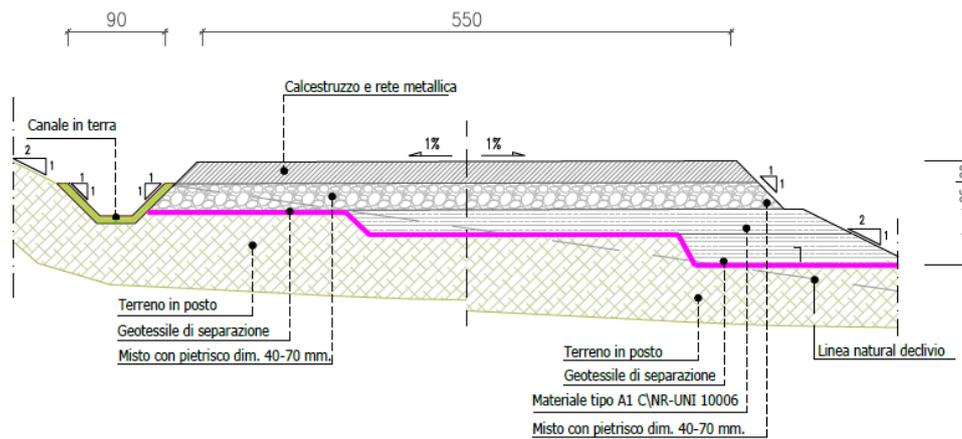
Sezione stradale tratto a mezzacosta (>13%)
